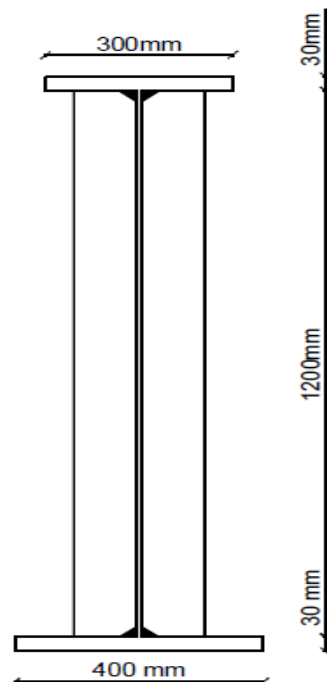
Vista frontal de la viga con soldadura tipo filete. Elaborado por: Autor
